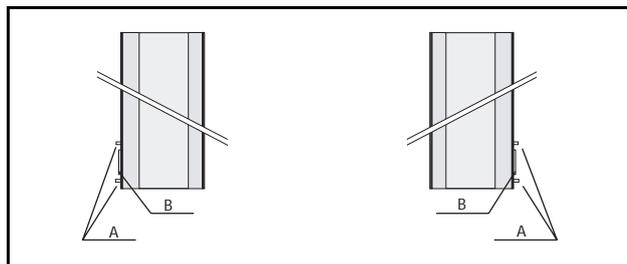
Attacchi: SYST MS, installazione diretta al soffitto, vista dal lato corto.
